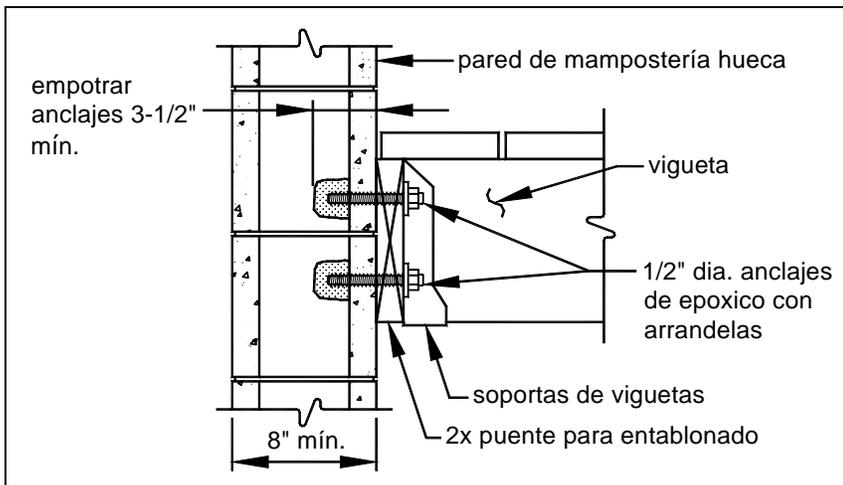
UNIÓN DEL PUENTE PARA ENTABLONADO CON LA PARED DE CIMENTACIÓN (MAMPOSTERÍA HUECA)
